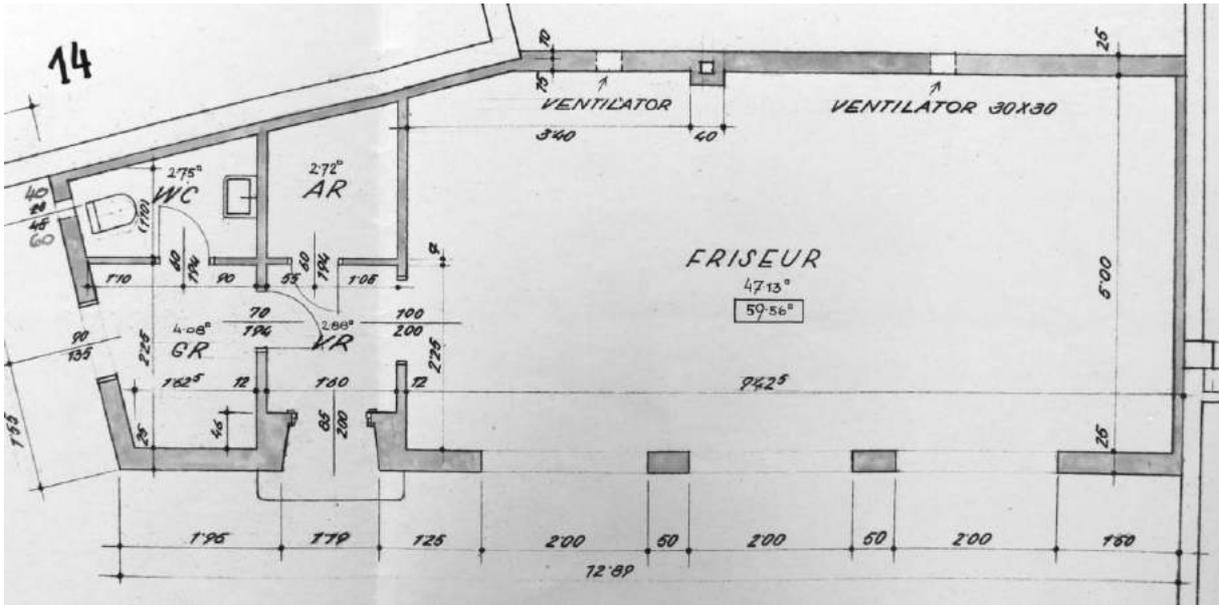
Grundriss Ladenbau - Friseur
